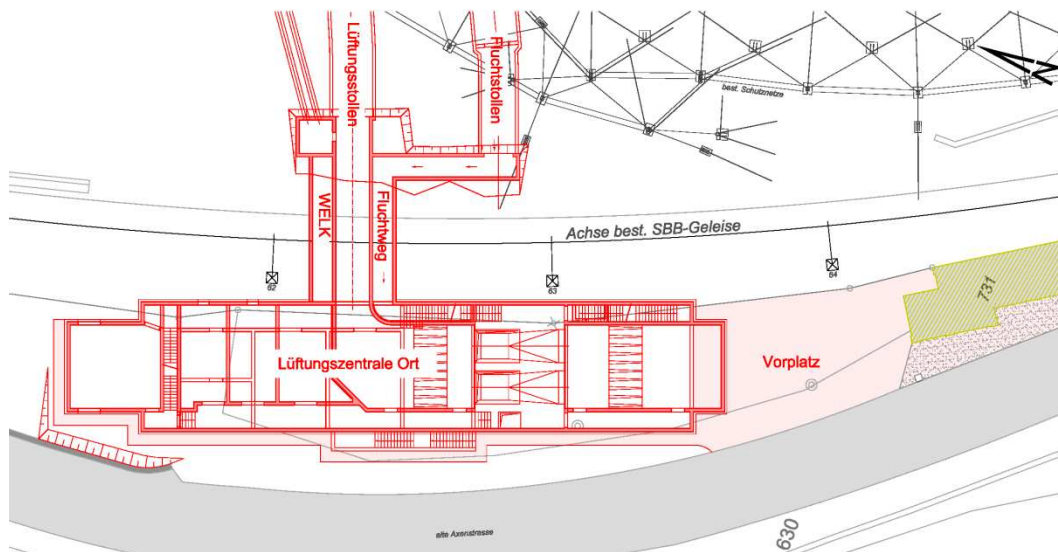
Grundriss Erdgeschoss Lüftungszentrale Ort
